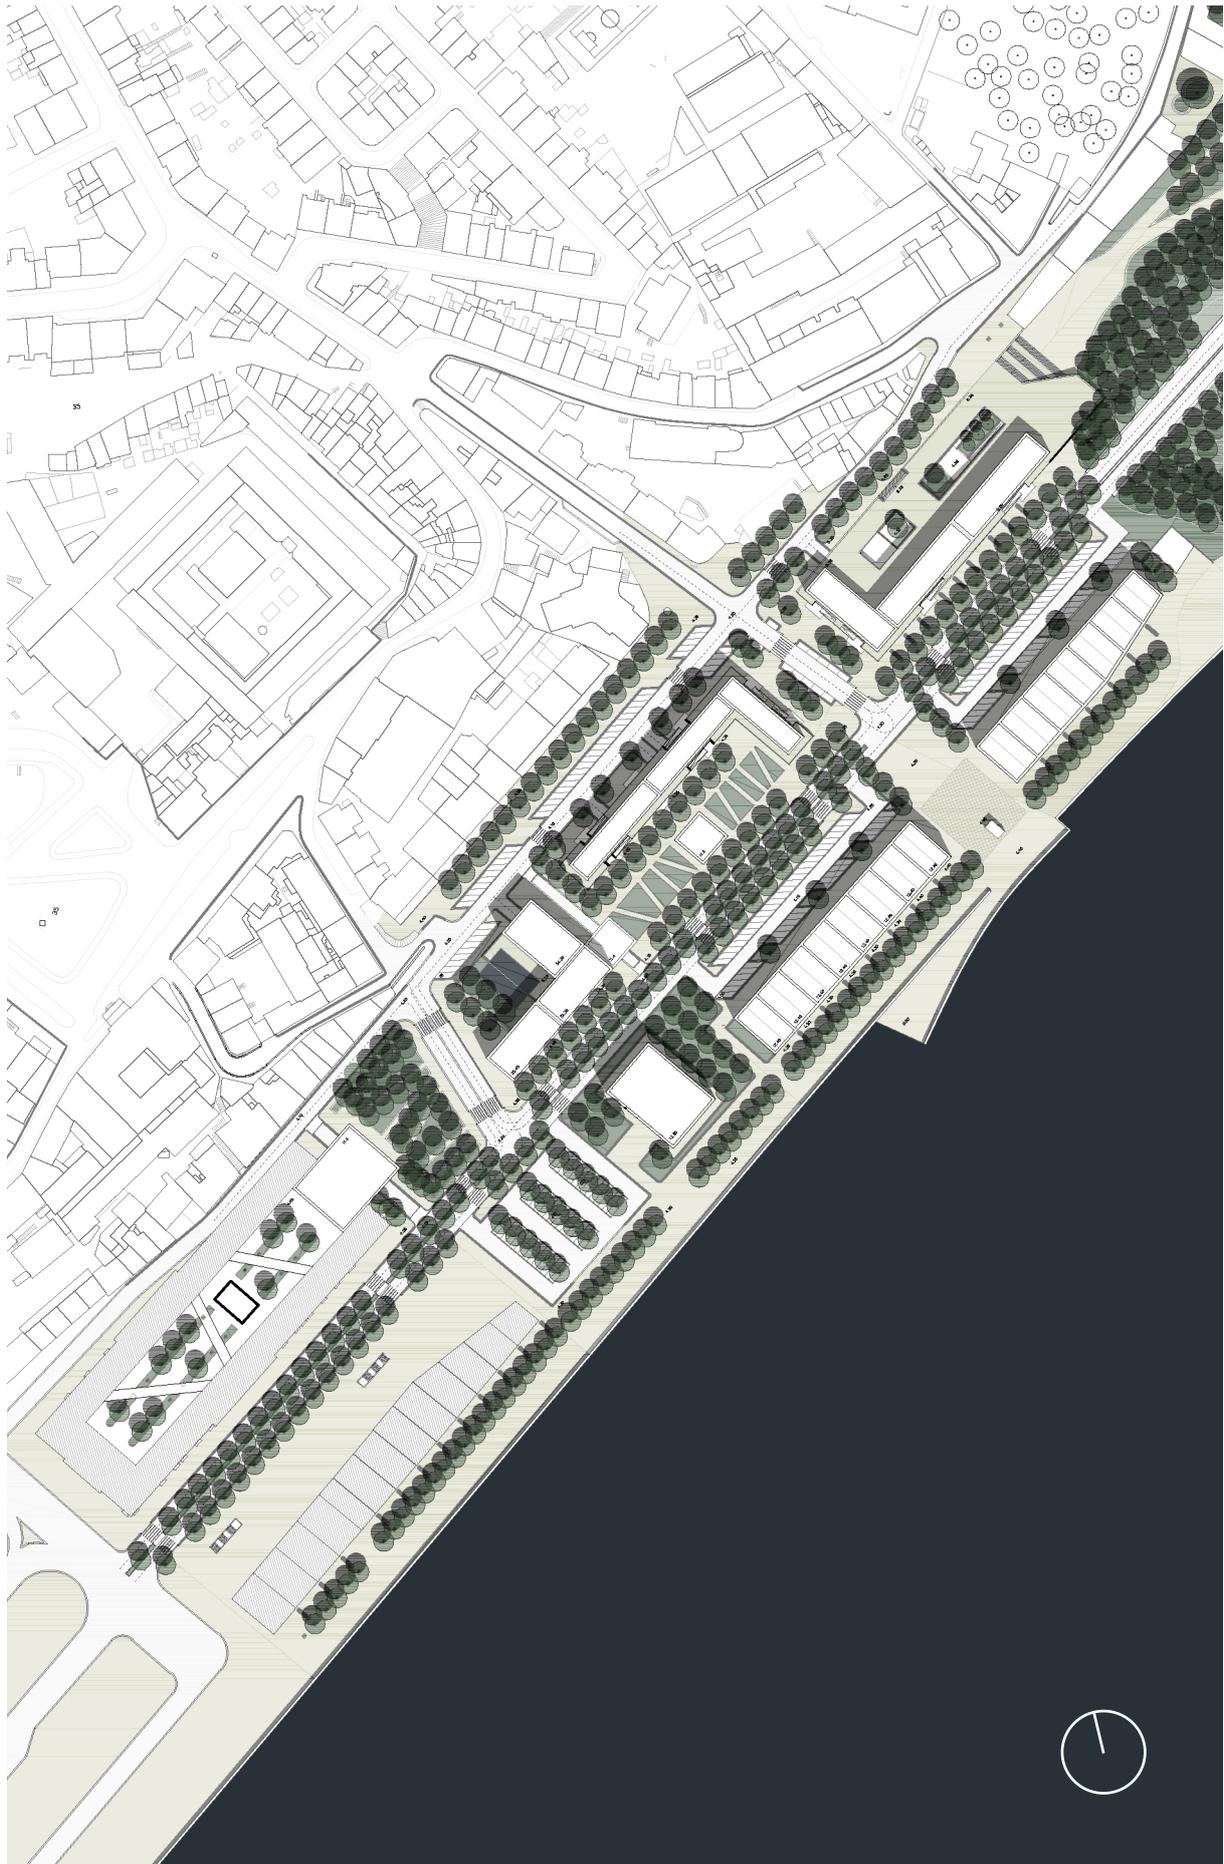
Planta Pormenorizada area habitacional A - 1:4000
